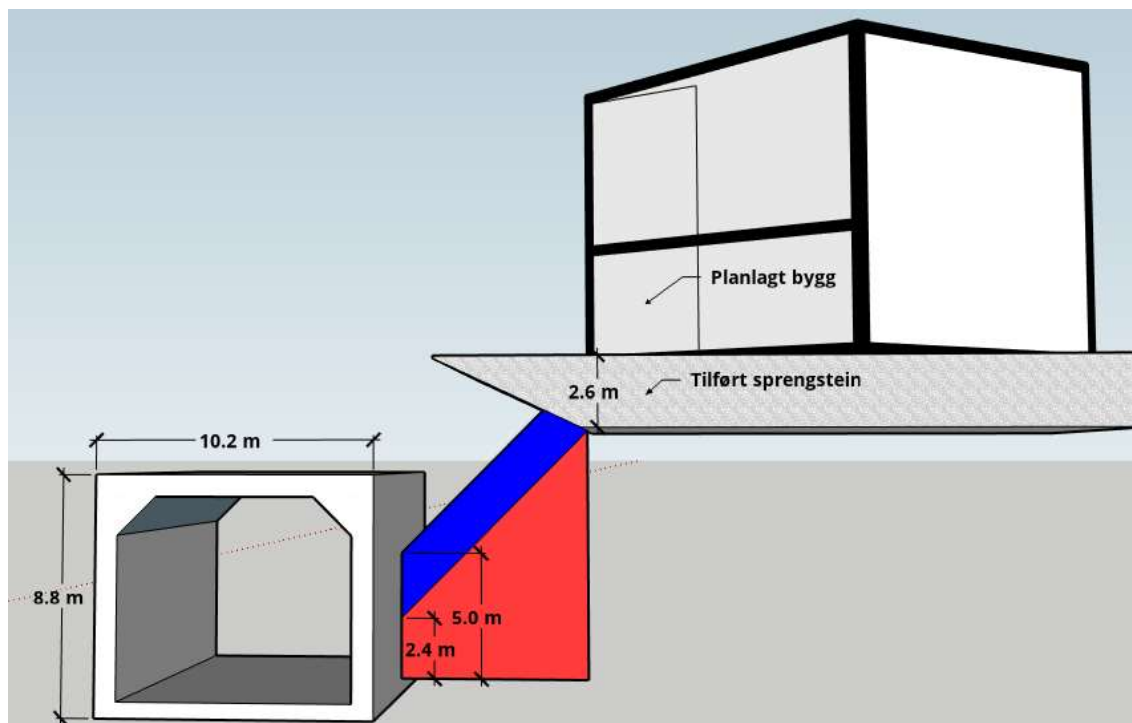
Snittegning av området hvor bygg under planlegging har minst avstand til bybanetunnelen.
